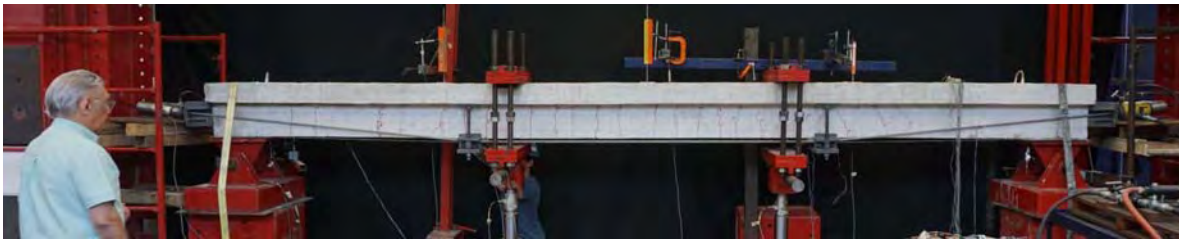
Viga 2 con presfuerzo externo aplicado y desviado
